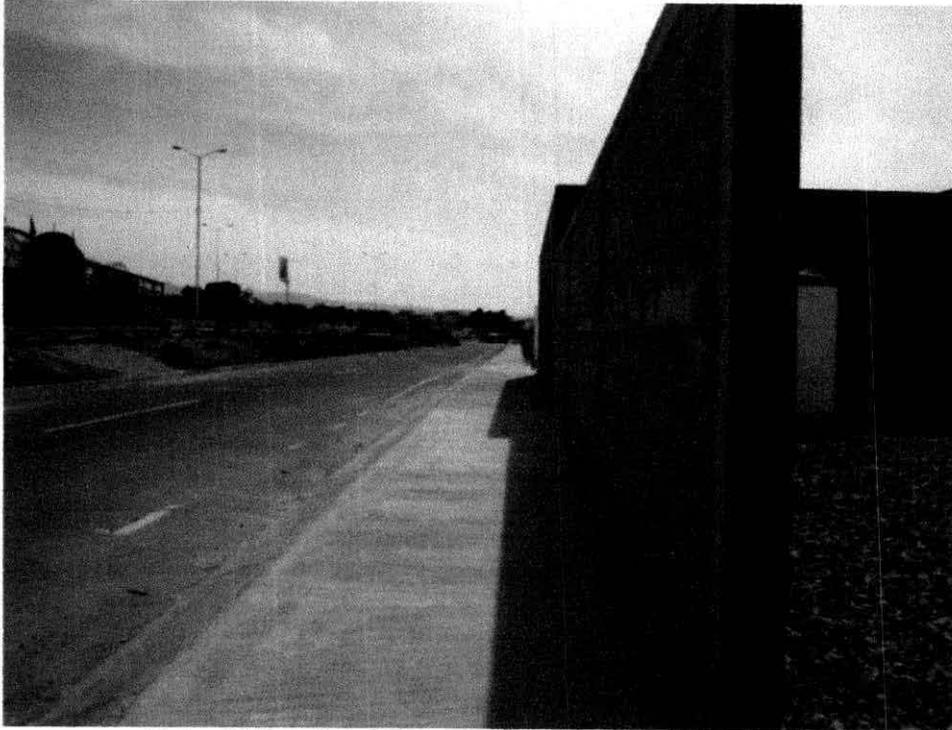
Vista de la colindancia Oriente.
